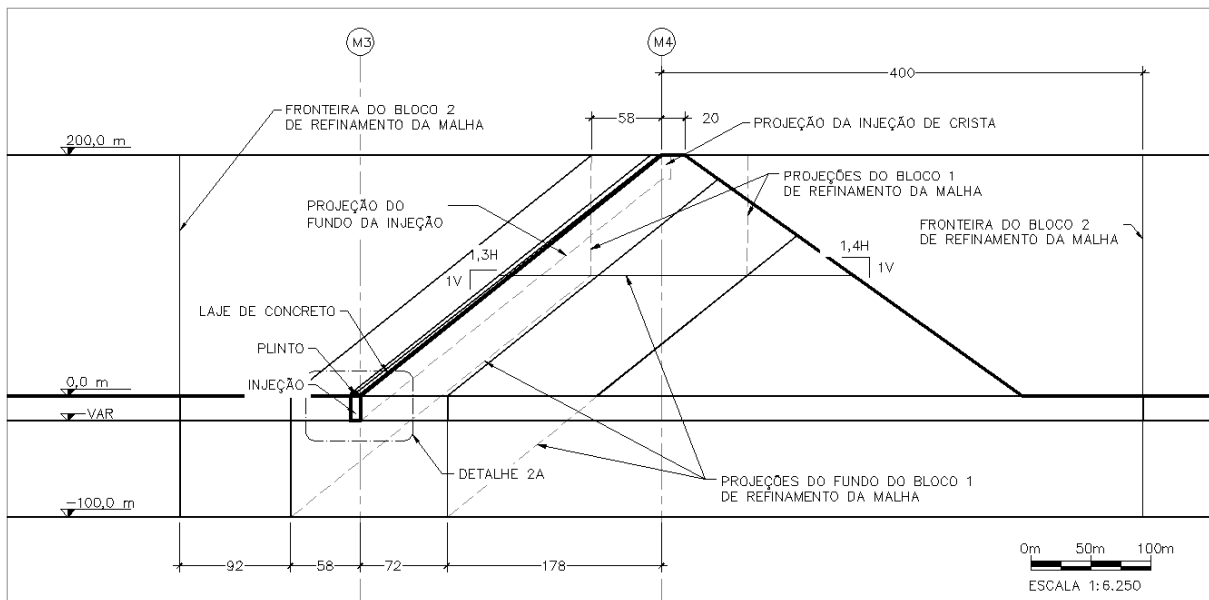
Corte 1A com o Detalhe 1A com subdivisões para a aplicação dos MEF. Escala 1:6.250.
